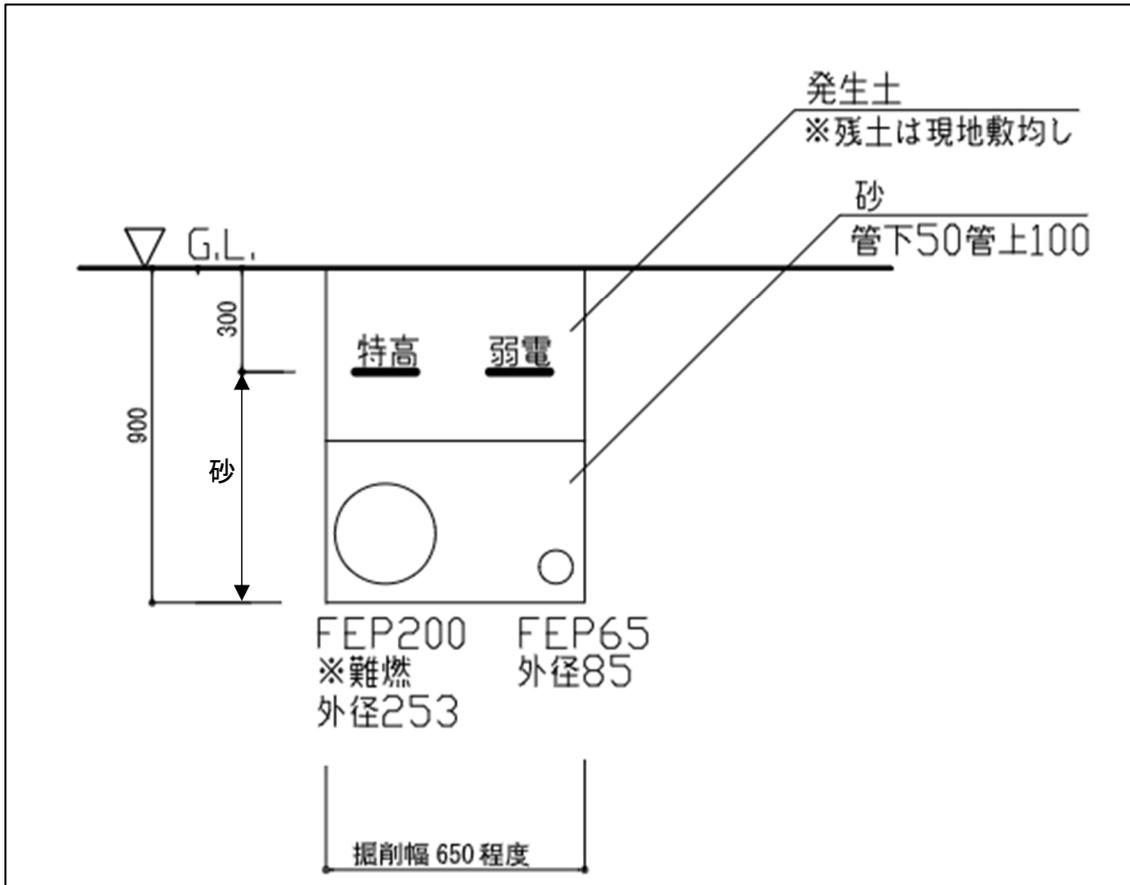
電線路敷設に用いる管路標準断面図 (例)
